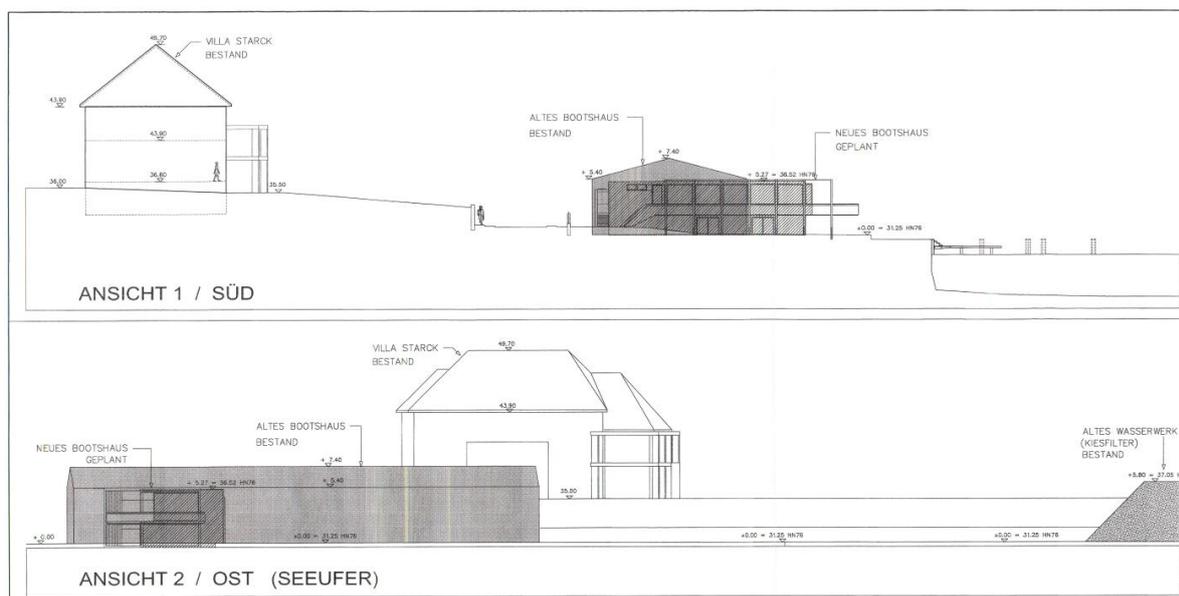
Gegenüberstellung NVA-Bootshalle und Bootshaus gemäß Planung 2004⁷
